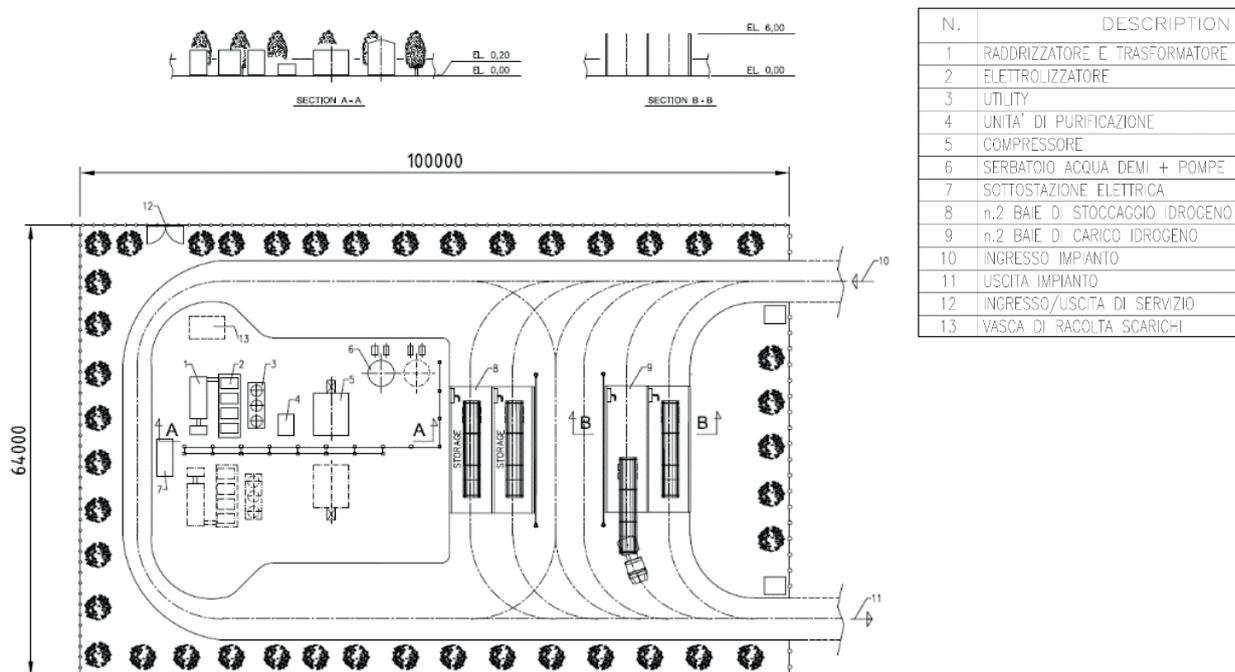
Planimetria preliminare dell'Impianto di Idrogeno Verde di Statte
